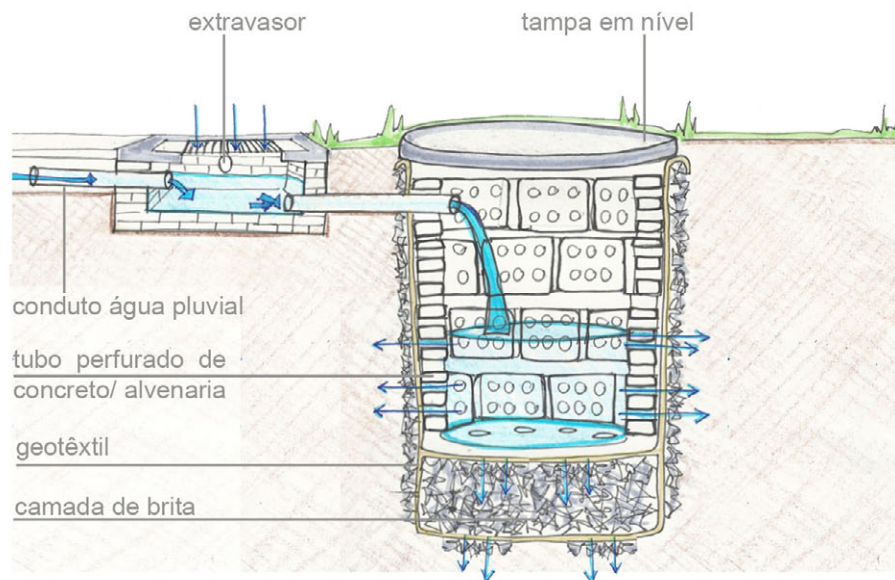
Poço de Infiltração em concreto pré-moldado. Ilustração: Bianca Habib, 2010, adaptado de Reis, 2005.
